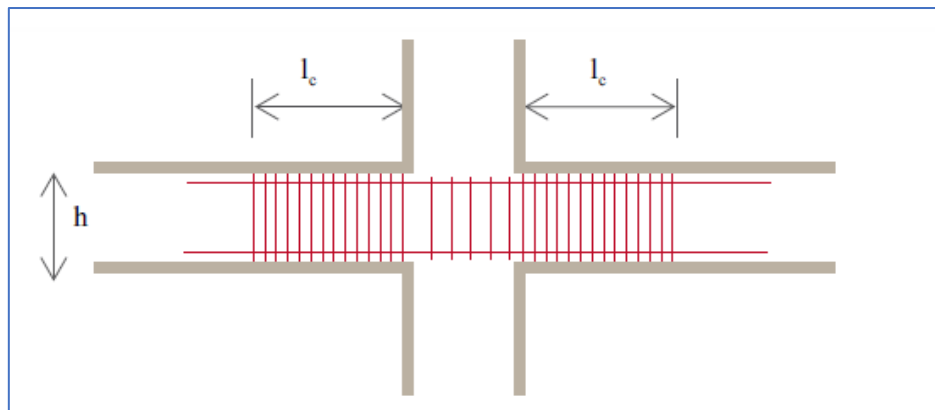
Zone critique d'une poutre (image prise du RPS2000 V2011 p.61)
